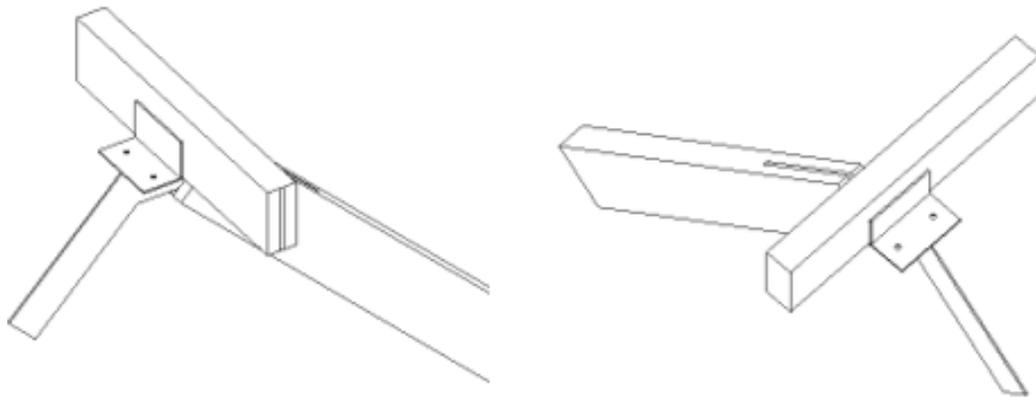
Conexión Estructural Acero - Madera. Elaboración Propia
